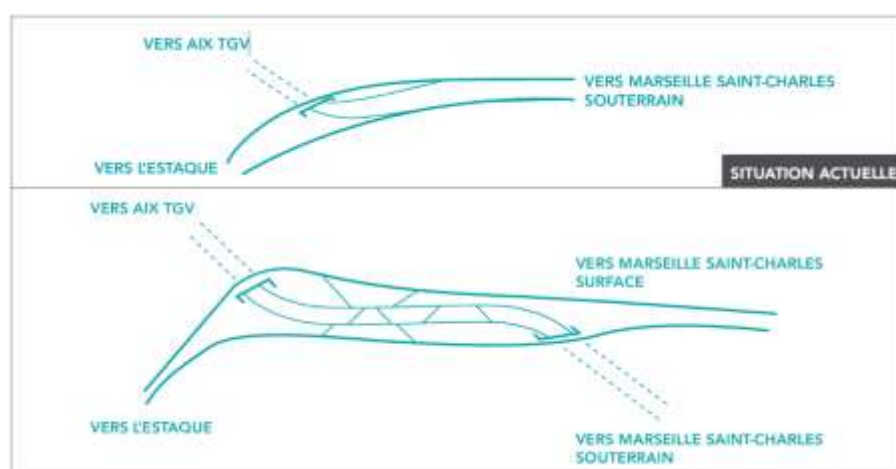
Schéma du raccordement d'entrée en tunnel au droit de la Delorme (Dossier de concertation 2021)
